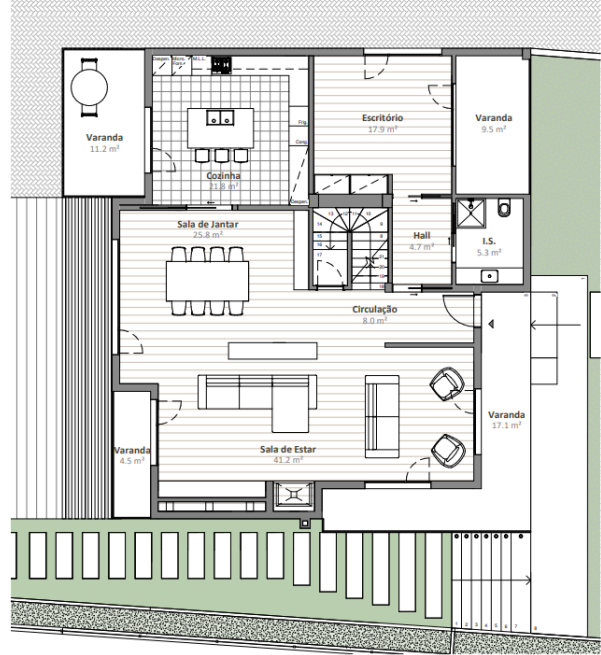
Proposto - Planta do piso 0 (EP_R01). Fonte: Garq / Desenvolvimento: Autora.
